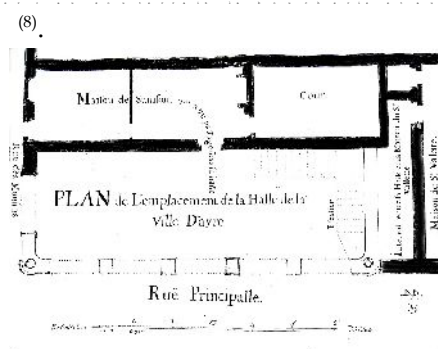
Halle proposée par Arnaud de Saint Félix
